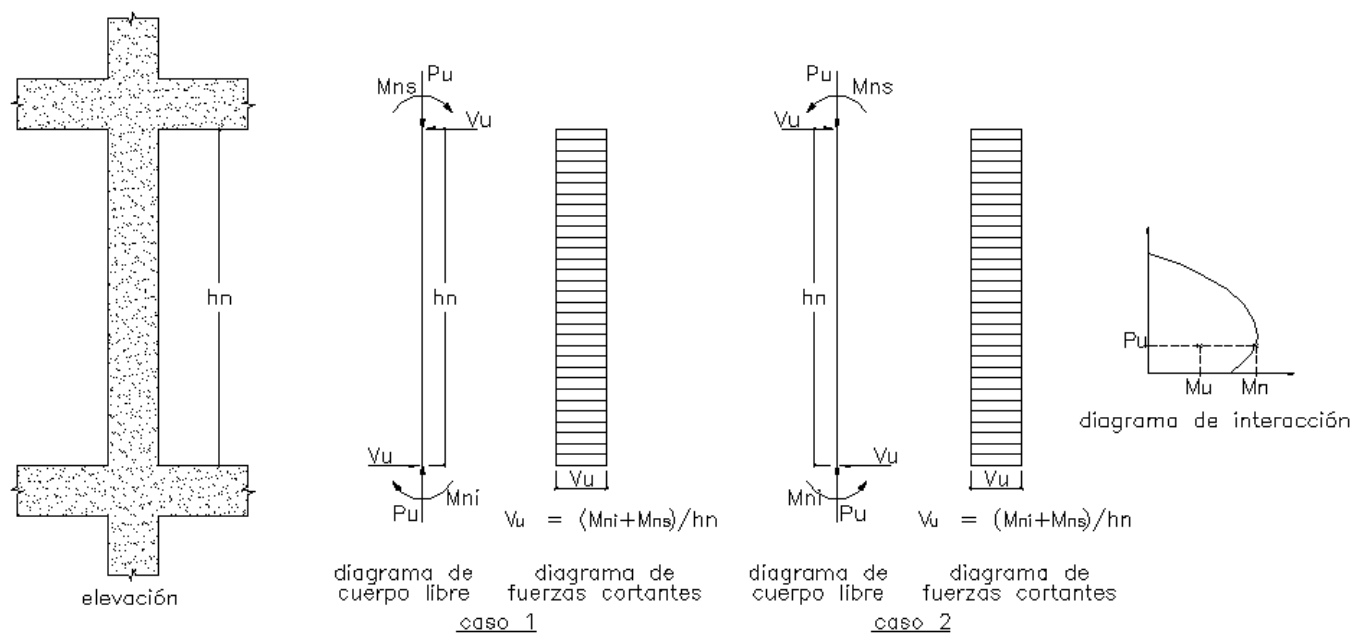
Fuerza cortante de diseño en columnas
